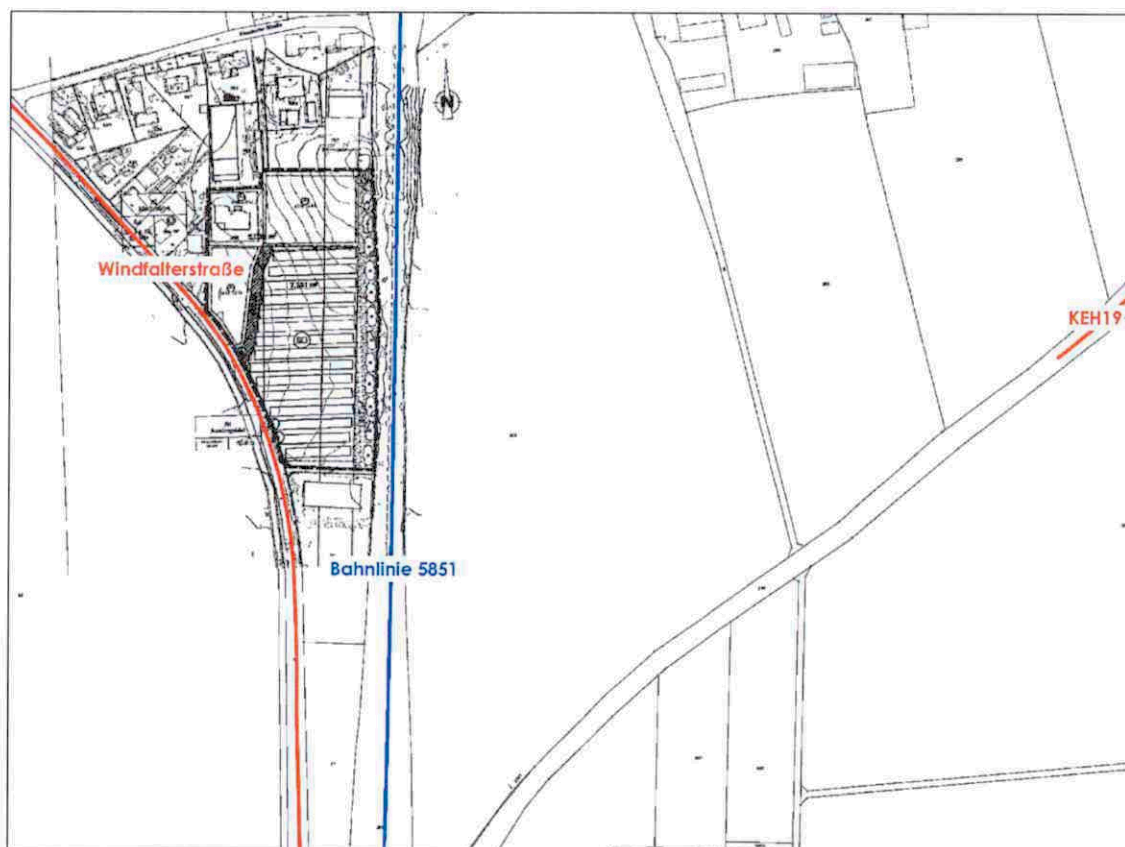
Lageplan mit auszugsweiser Darstellung der für die Untersuchung relevanten Immissionsorte (IO)
